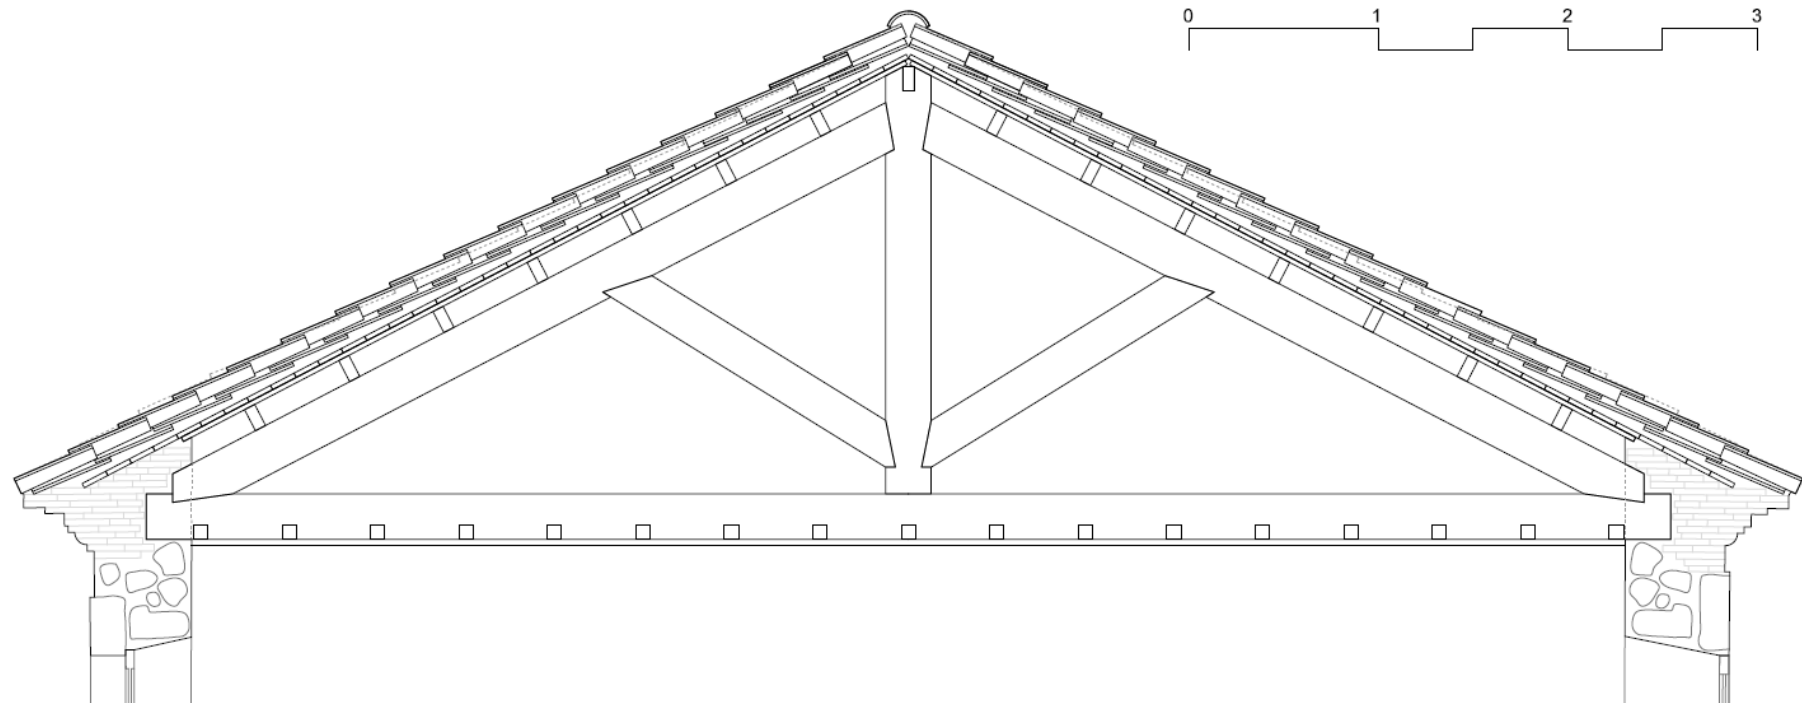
Detalle constructivo de la cubierta principal y cielo raso.
